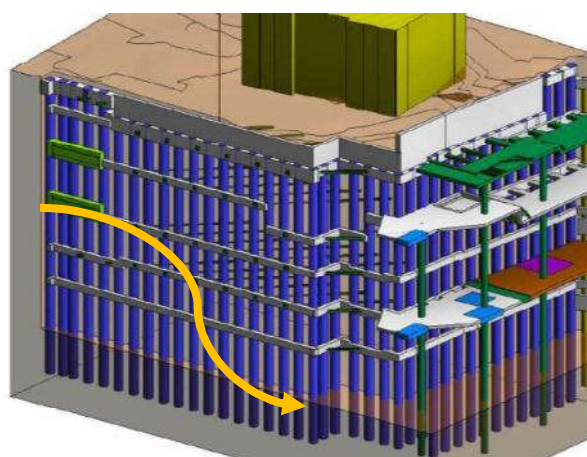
Alçado Sudoeste – zona de rampa de acesso à escavação.
